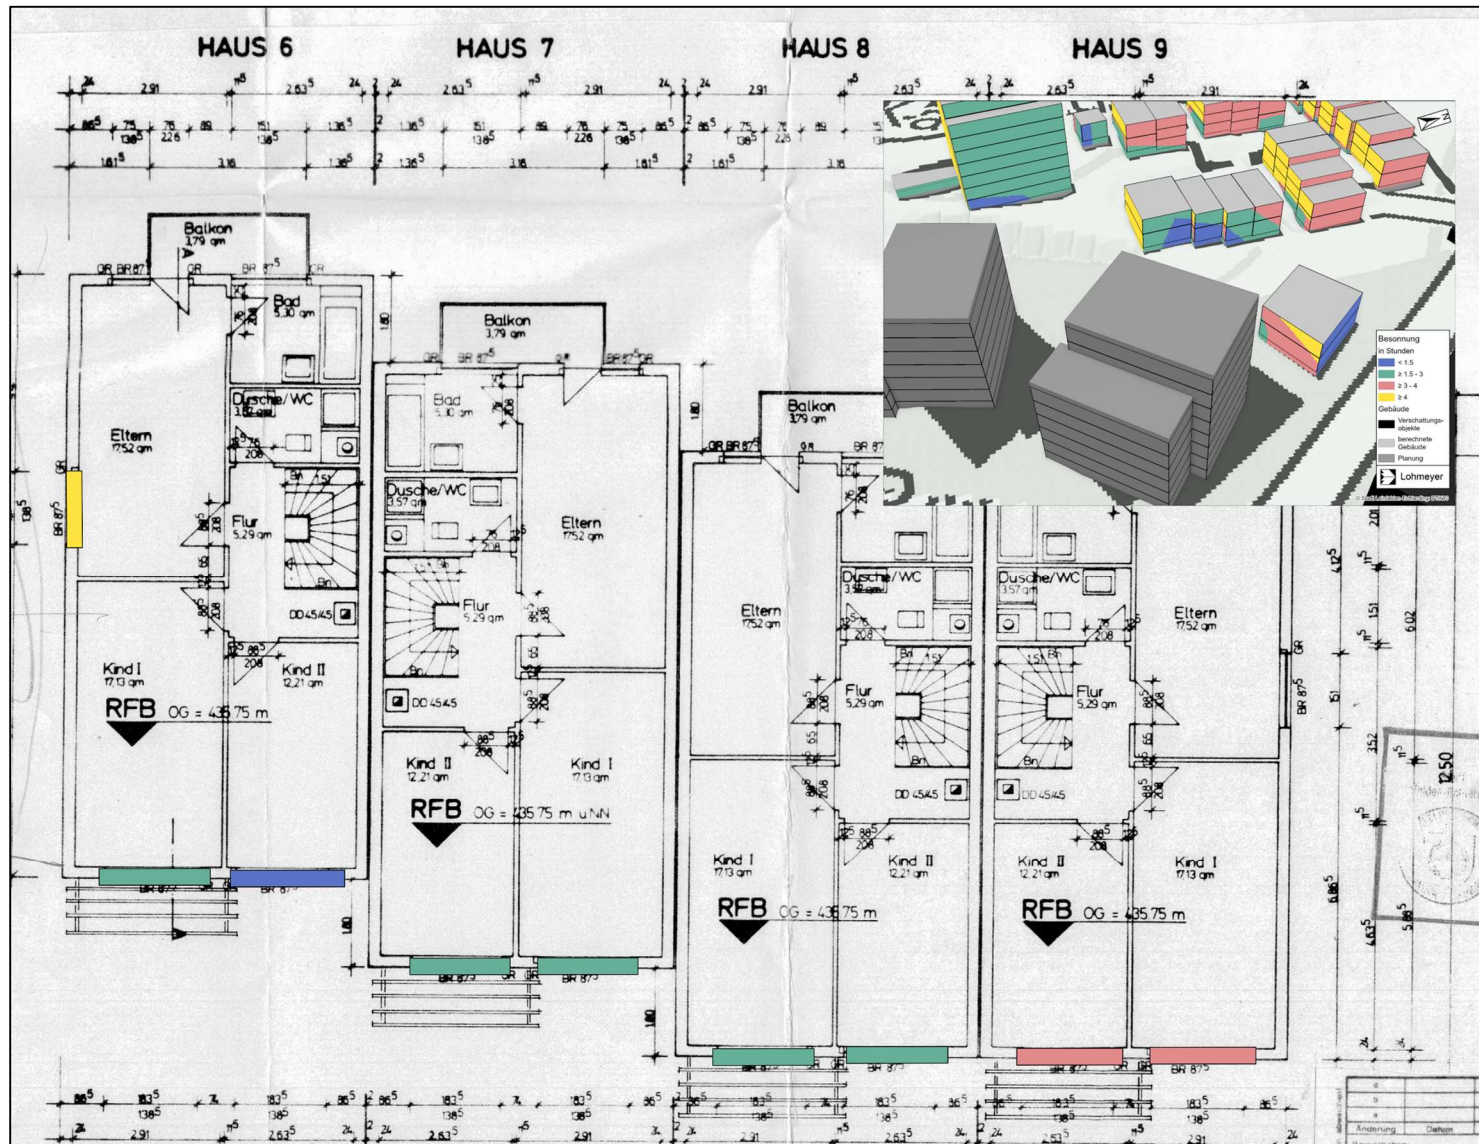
Grundrisse der Kapfstraße 42 bis 48 im 1. Obergeschoss und direkte Besonnungsdauer an den zur Planung zugewandten Fenstern
